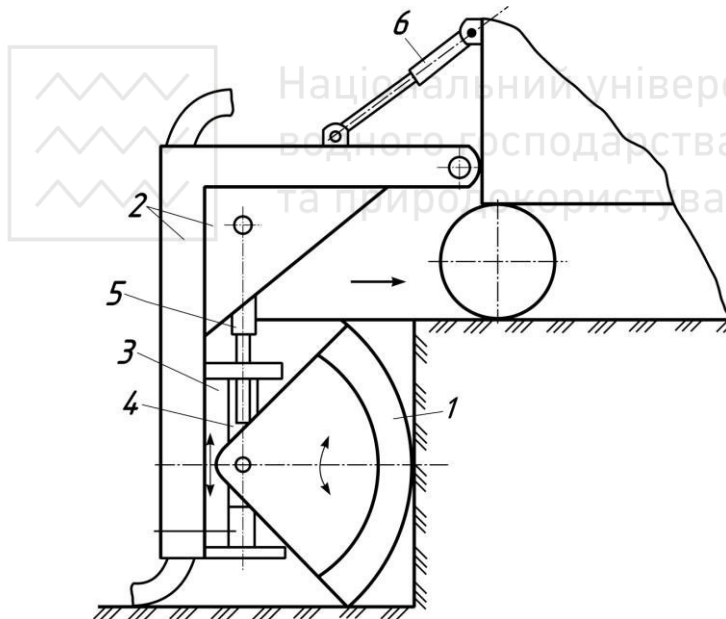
Схема робочого обладнання землерийної машини з шарнірно-поворотним сектором:
